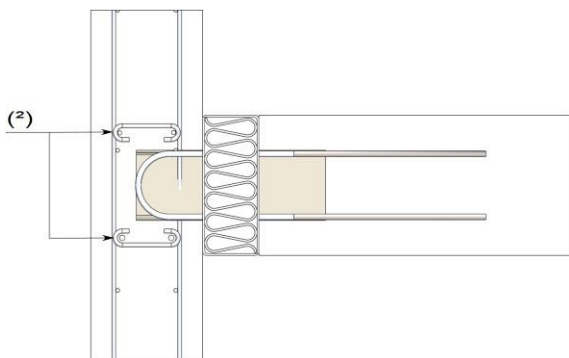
Chainage de mur – liaison dalle – façade - disposition 1 (vue en coupe)
